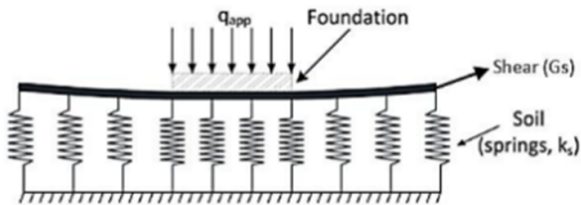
Pemodelan lapisan lapisan pendukung Winkler
